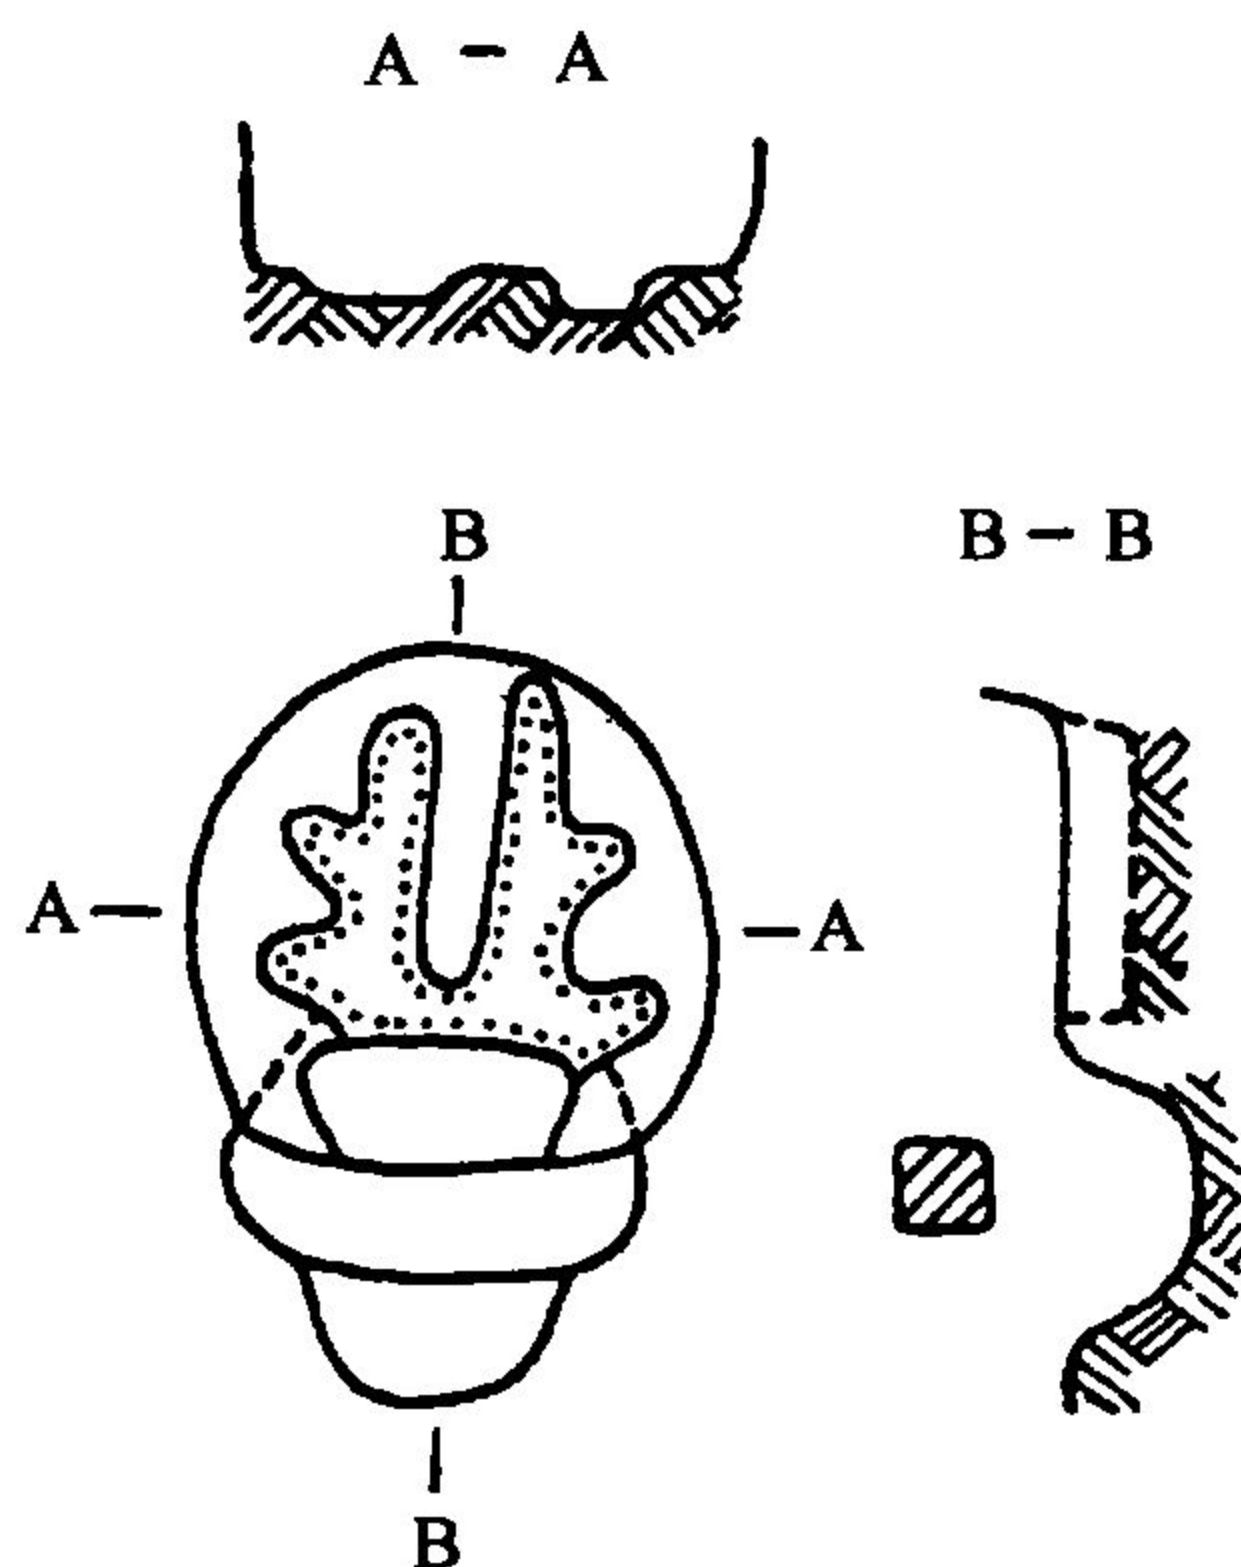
郑州林山砦仰韶文化陶窑平面剖面图
